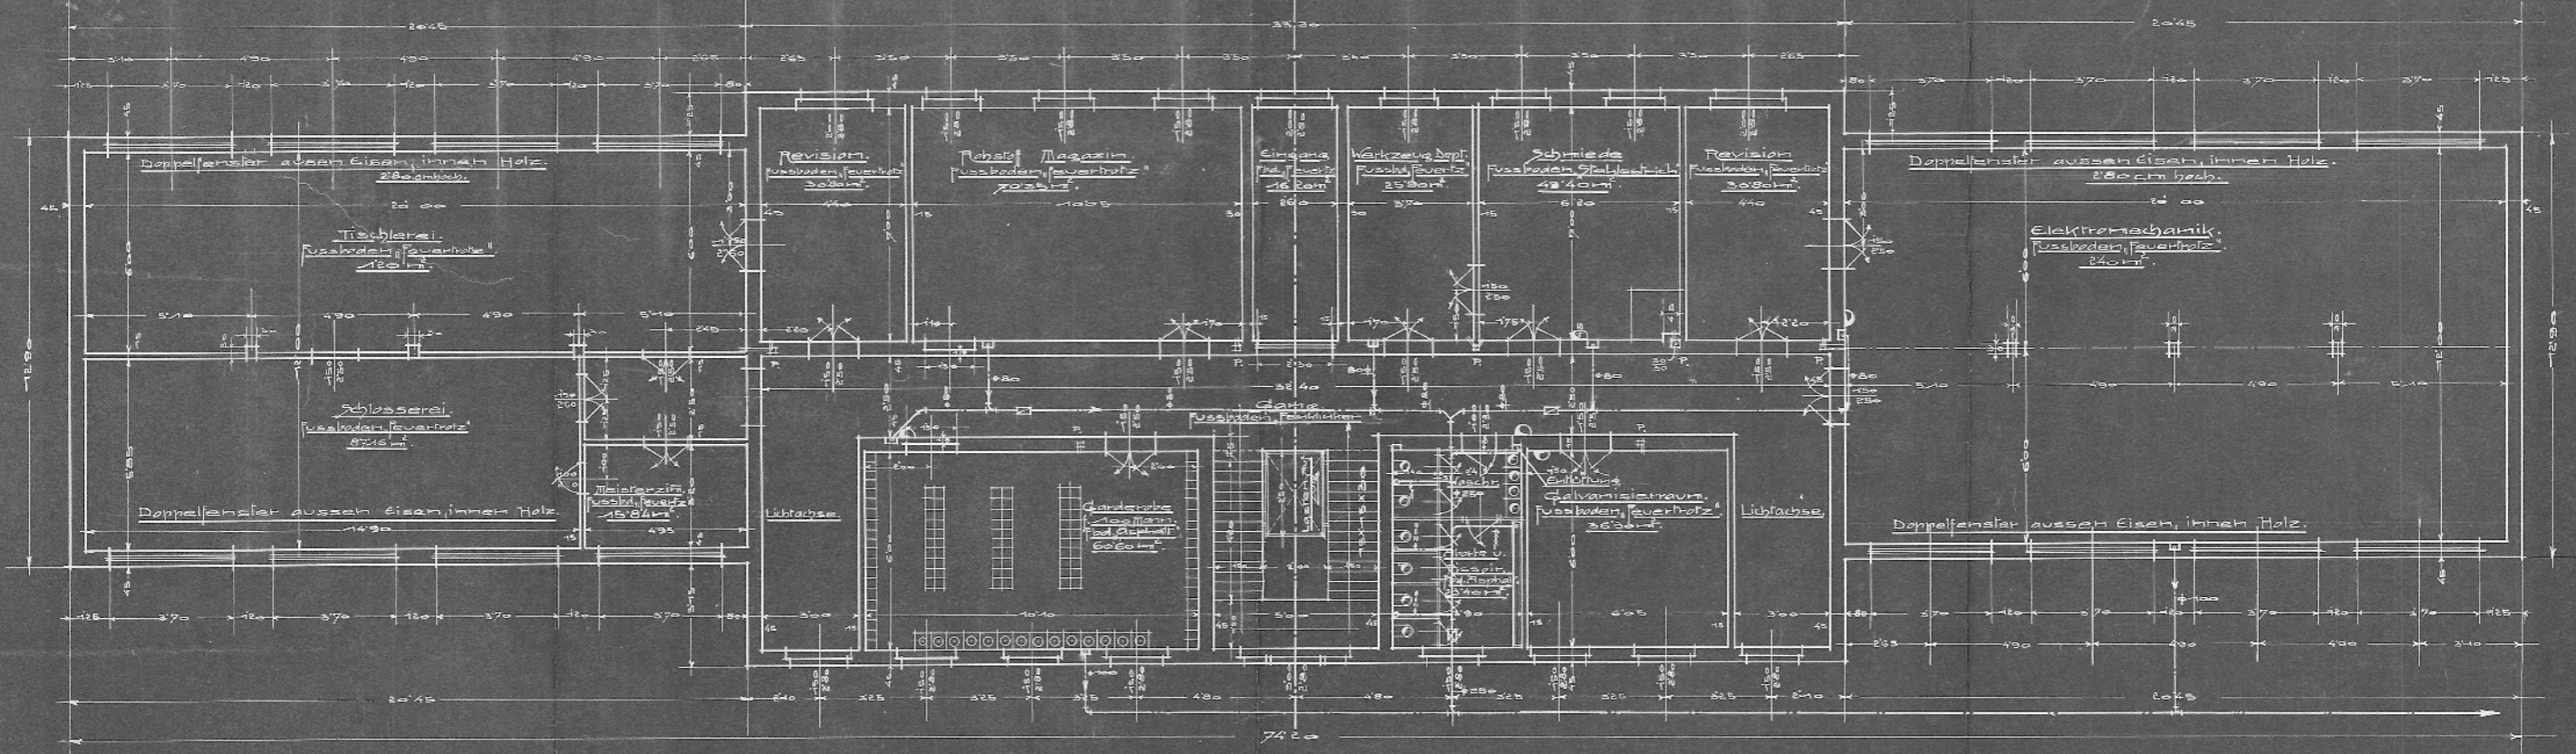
Originalplan Werksgebäude Nr. 210 Grundriss EG, Februar 1916
